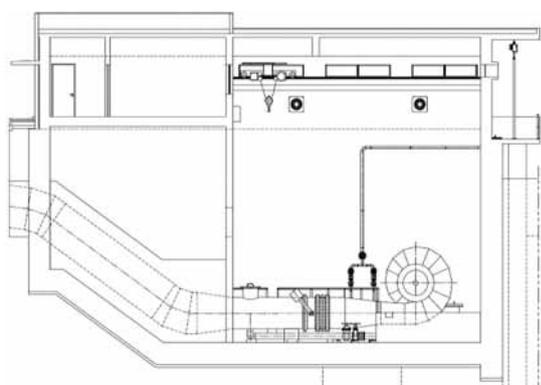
Mini-hídricas de Odivelas – Perfil Tipo e vista interior
